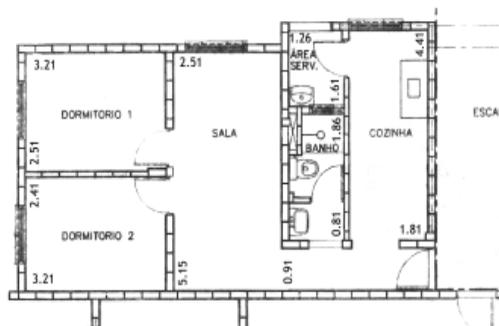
planta CDHU tipo VI-22 K – Caderno de Tipologias de edificações da CDHU. Área das unidades 44,95 m² com dois dormitórios.
